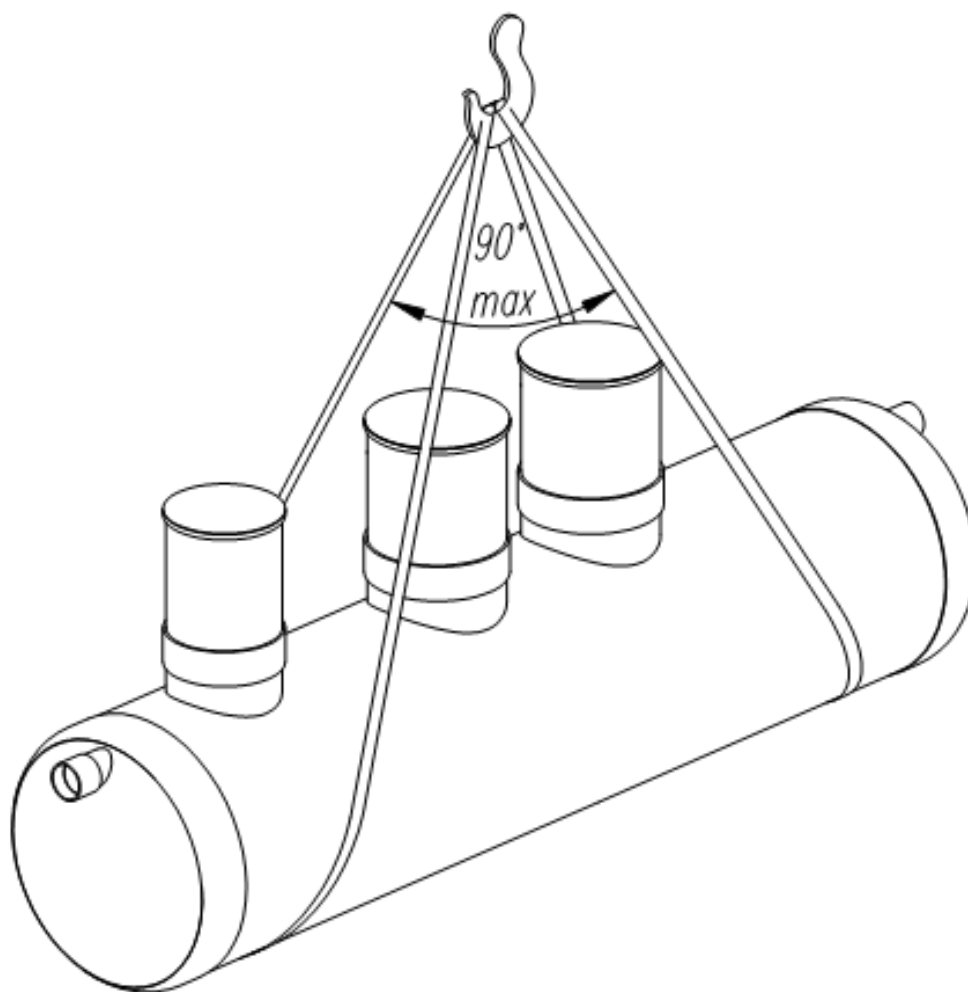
Схема строповки очистных сооружений в едином корпусе длиной до 6 метров.
